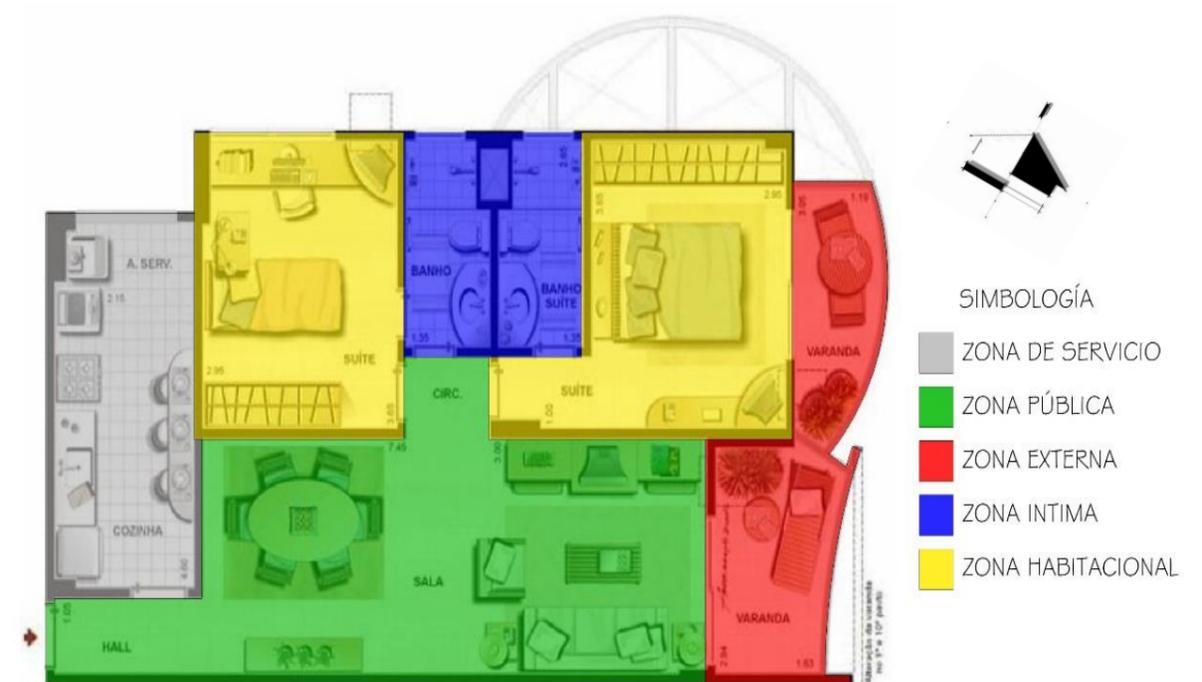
Zonificacion de la Suite N° 2. Fuente: Autores.
